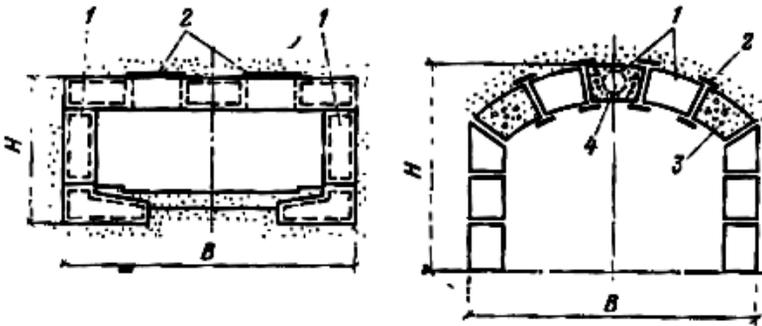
Схемы экранов, входящих в состав конструкции тоннеля: 1 – кораба; 2 – накладки; 3 – бетонное заполнение; 4 – опережающая
